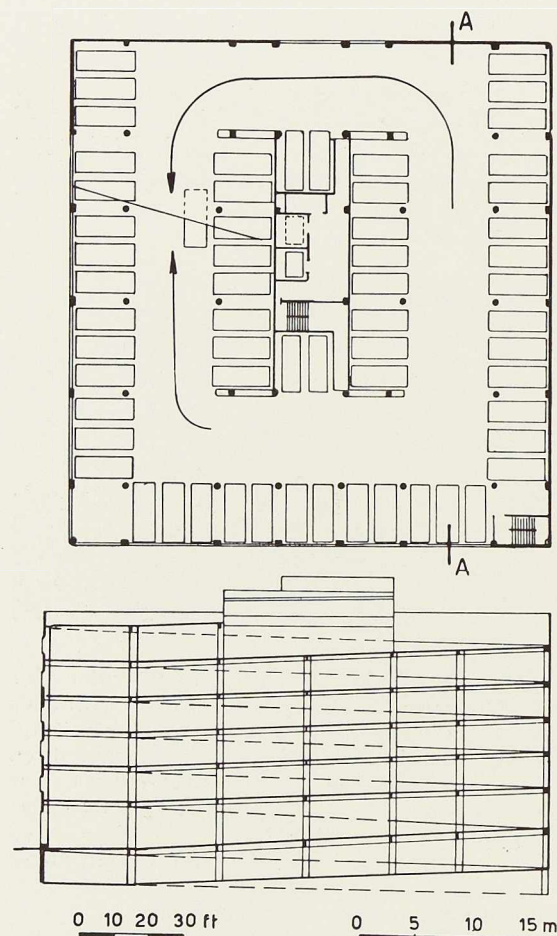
Plan et coupe d'un garage à Los Angeles (Californie).
